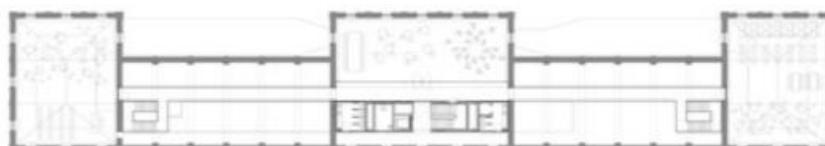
Planta baixa do 2º pavimento da Estação de Burgos. Autor: Contell – Martínez Arquitectos. 2016. Fonte: Acervo site Archdaily. Acesso em Junho/2018
